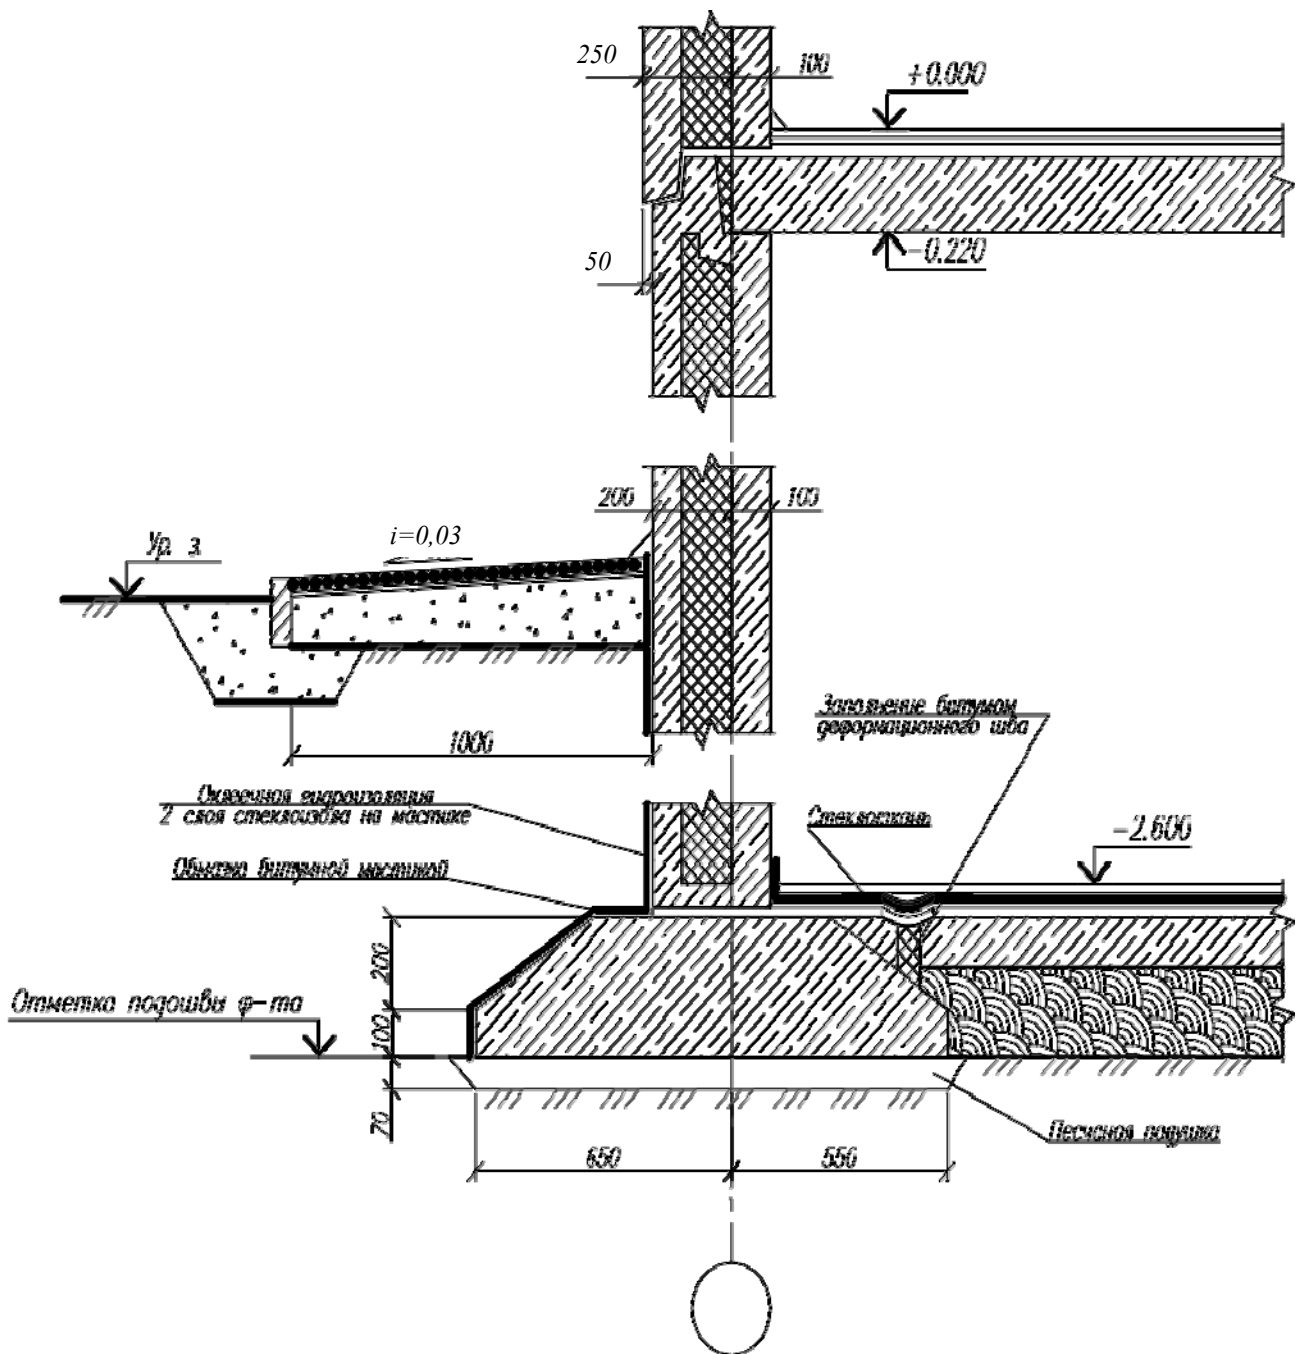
Узел сборного железобетонного ленточного фундамента под трехслойные наружные несущие стены
